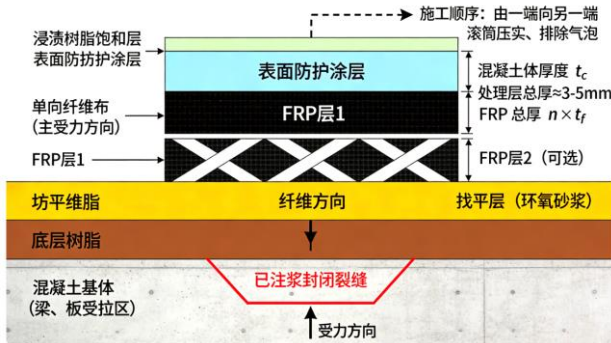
粘贴纤维复合材料(FRP)加固混凝土裂缝区域施工示意图
